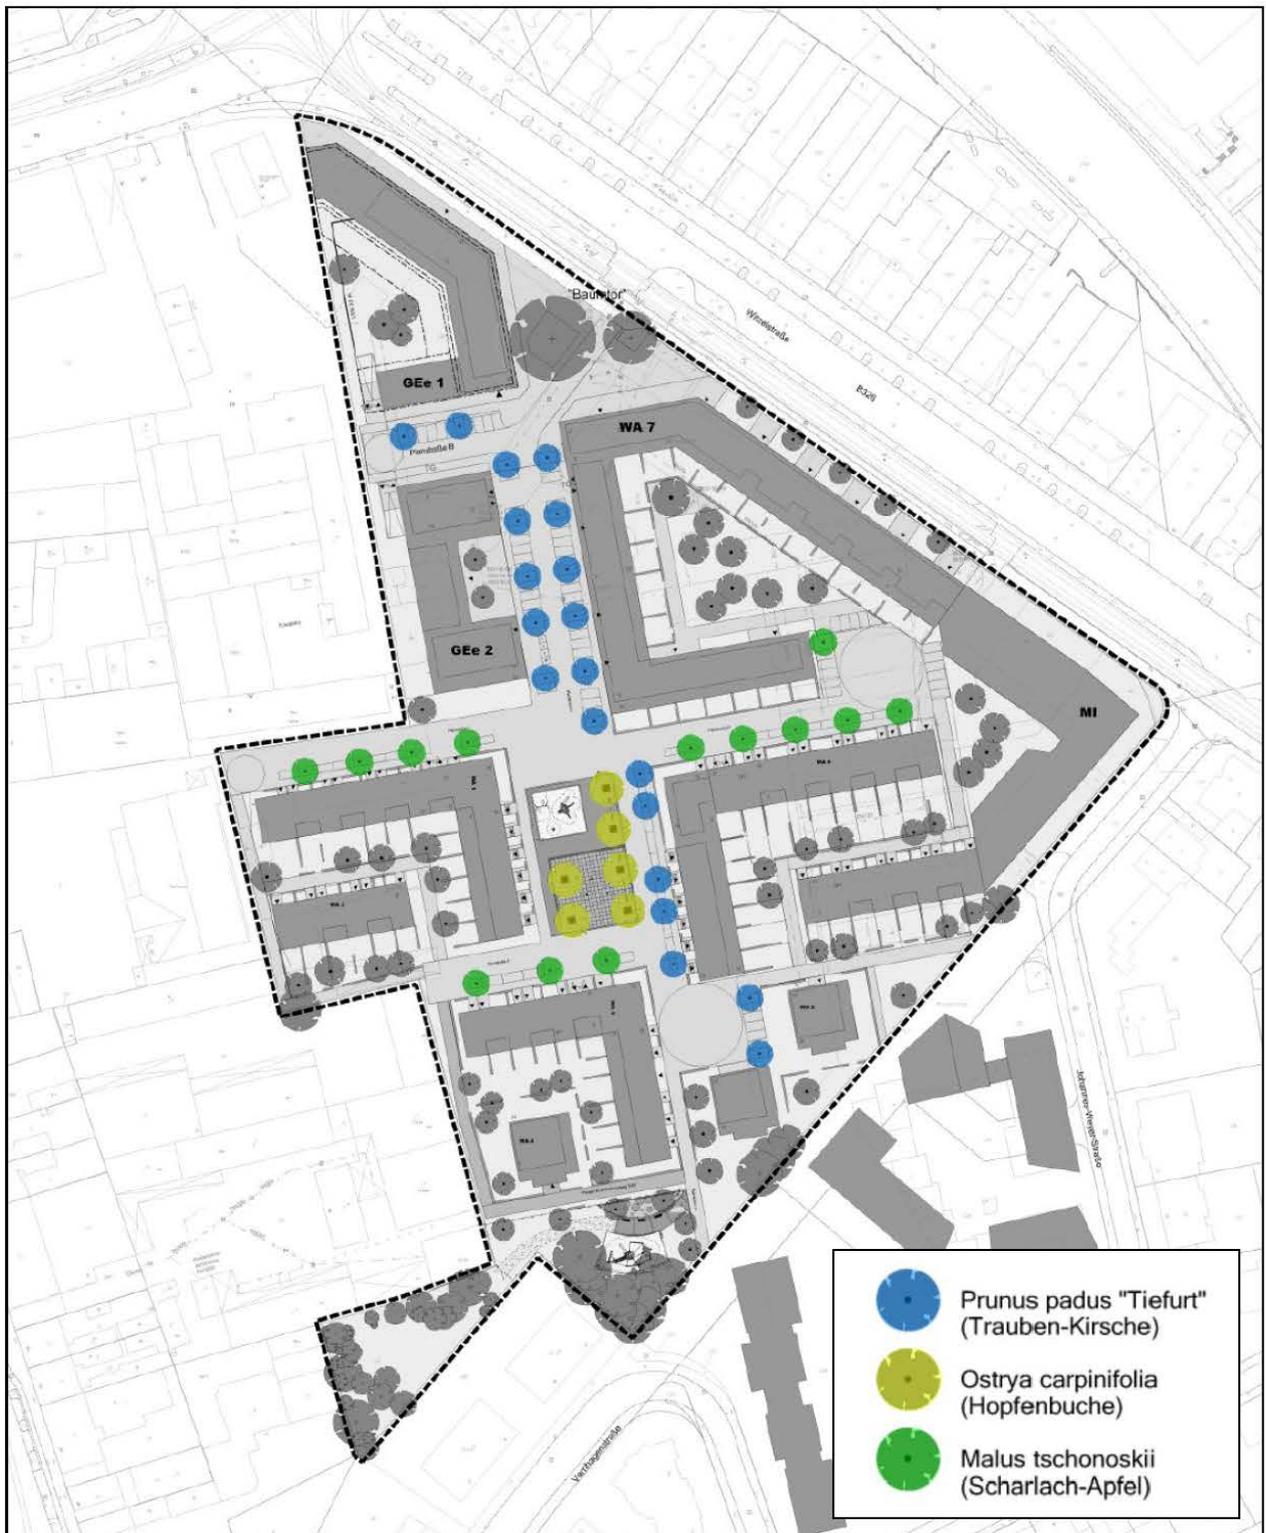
Öffentliche Straßenbäume – Planung (Quelle: Normann, Juni 2016)
